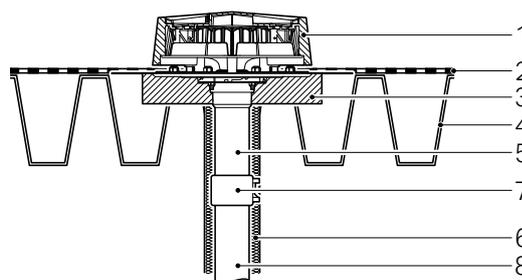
Dachaufbau ungedämmtes Dach Leichtbau – Geberit Pluvia Dachwassereinlauf mit Flansch für Kunststoff-Folien
